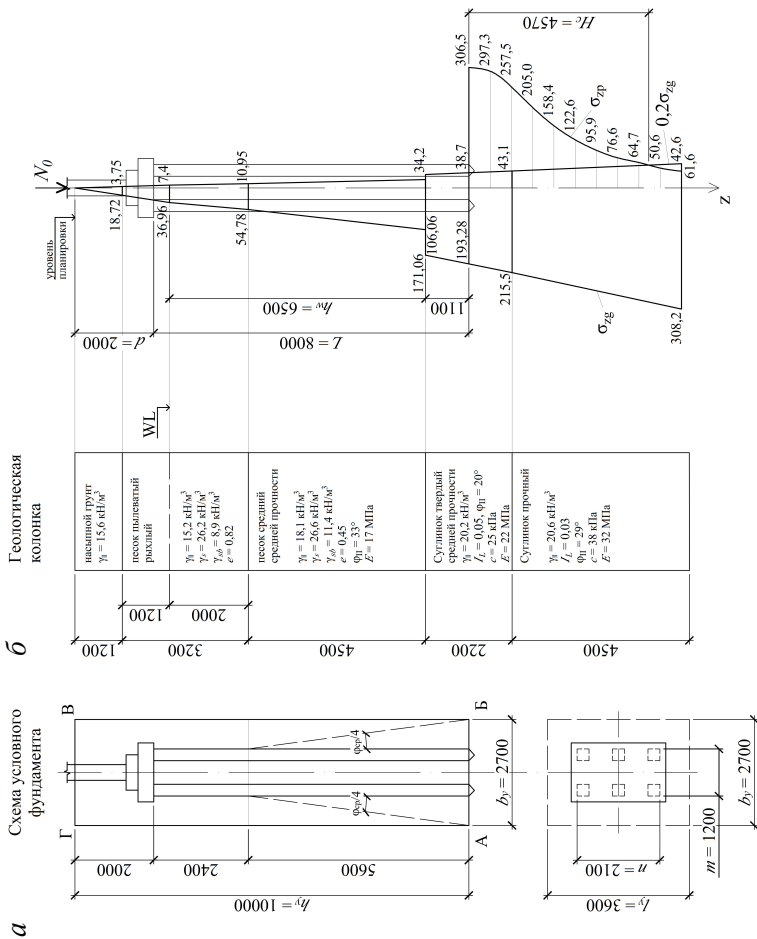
Расчетная схема для определения осадки свайного фундамента:
